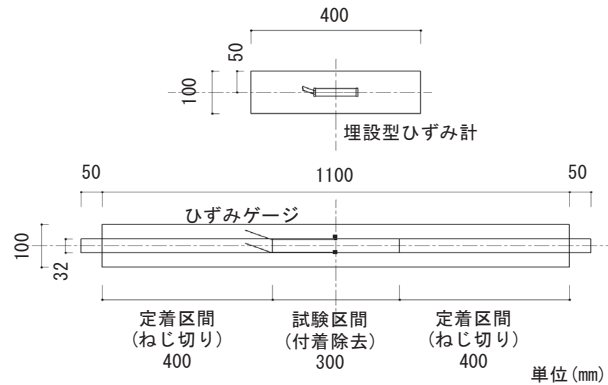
自由膨張収縮量試験(上)とひび割れ抵抗性試験(下)の試験体形状寸法
